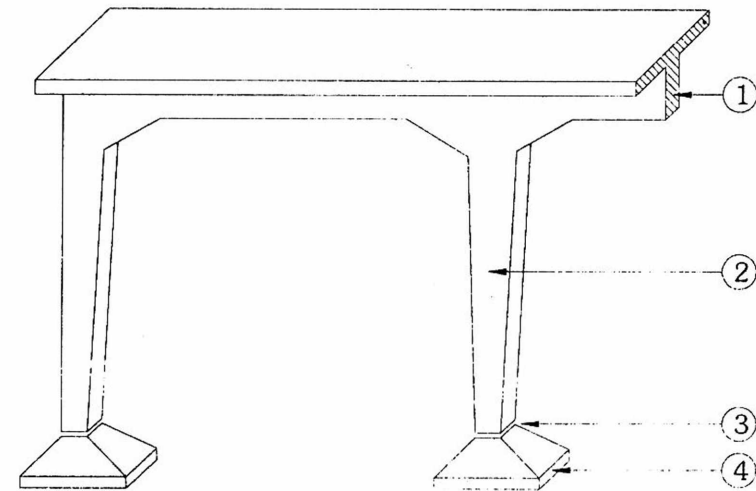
Solamente 1) viga; y 2) columna forman el pórtico. Se mide hasta 3) donde comienza la base 4).
